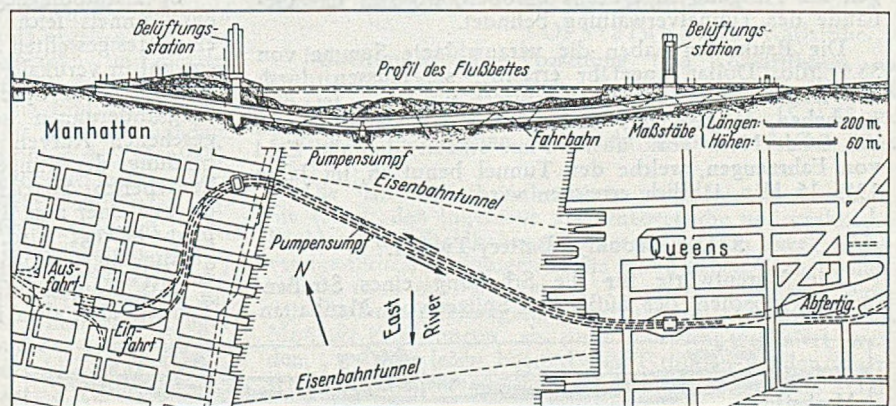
Lageplan und Längsschnitt des Queens-Midtown-Tunnels unter dem East-River.
